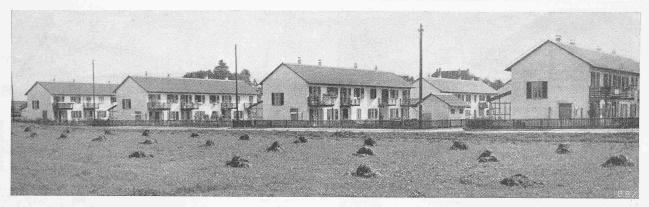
Wohnhaus-Kolonie Stapfenacker in Bern, aus Westen. Vierhäusergruppen Typ A, Grundrisse siebe Seite 30
